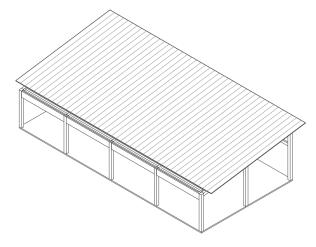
Axonometría estructural tipo 1_8 Fuente: Autores. 2024
